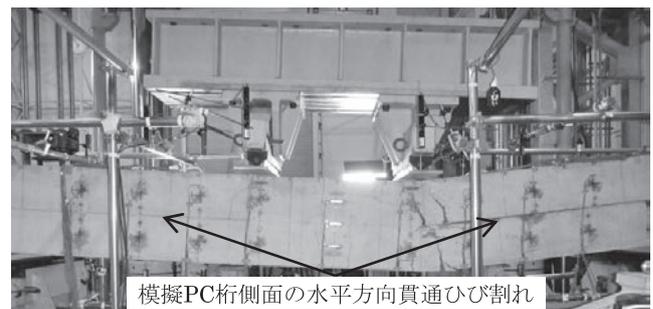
ひび割れ模擬PC桁のせん断試験
